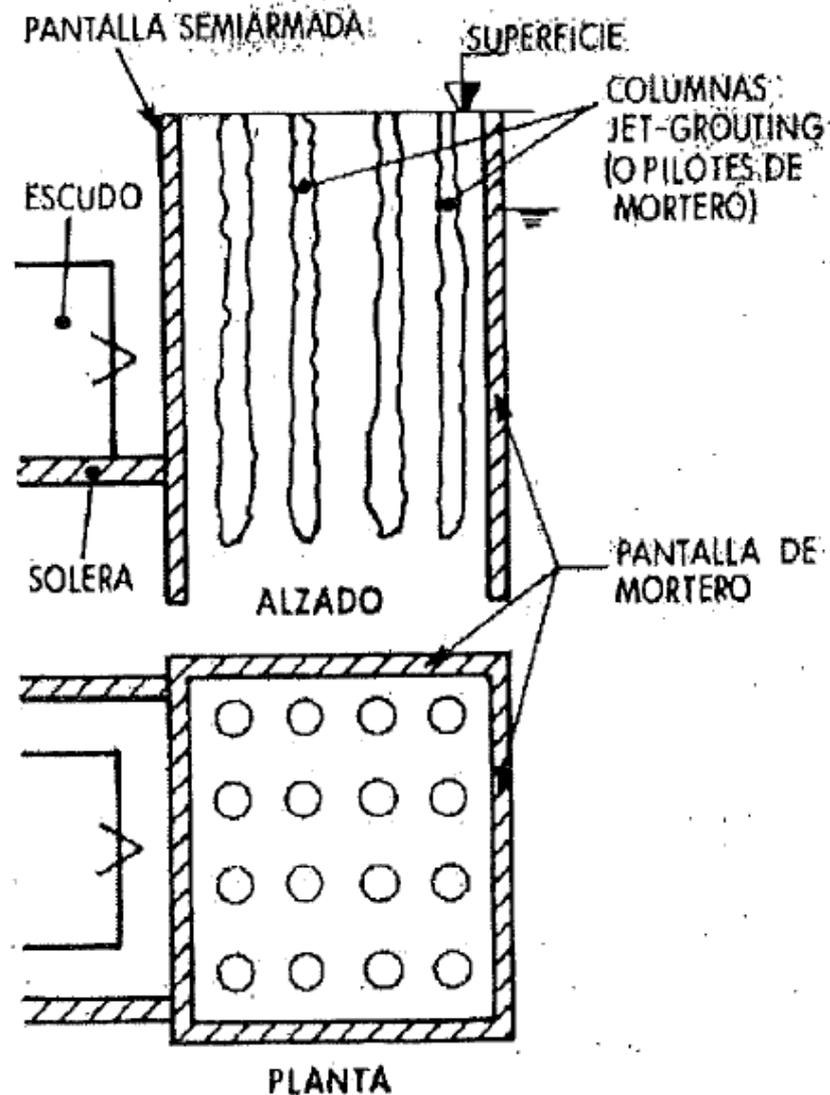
Jet grouting para el refuerzo del terreno en la llegada de las tuneladoras a las estaciones
